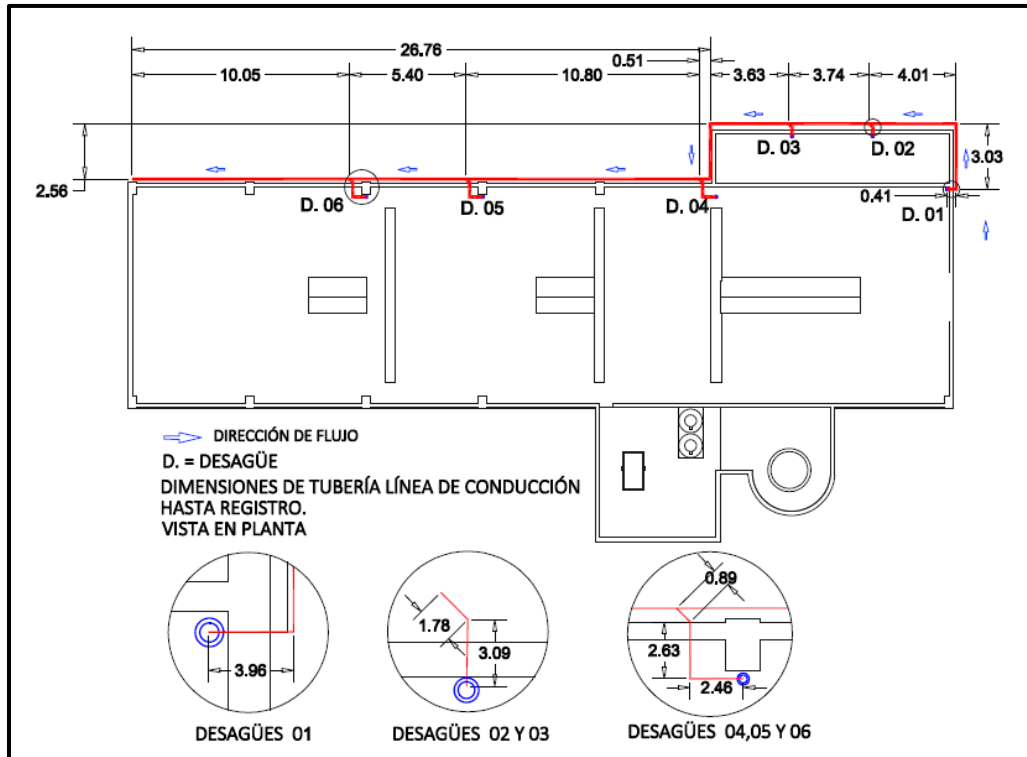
Longitud de la tubería tipo PVC en planta (en rojo)
